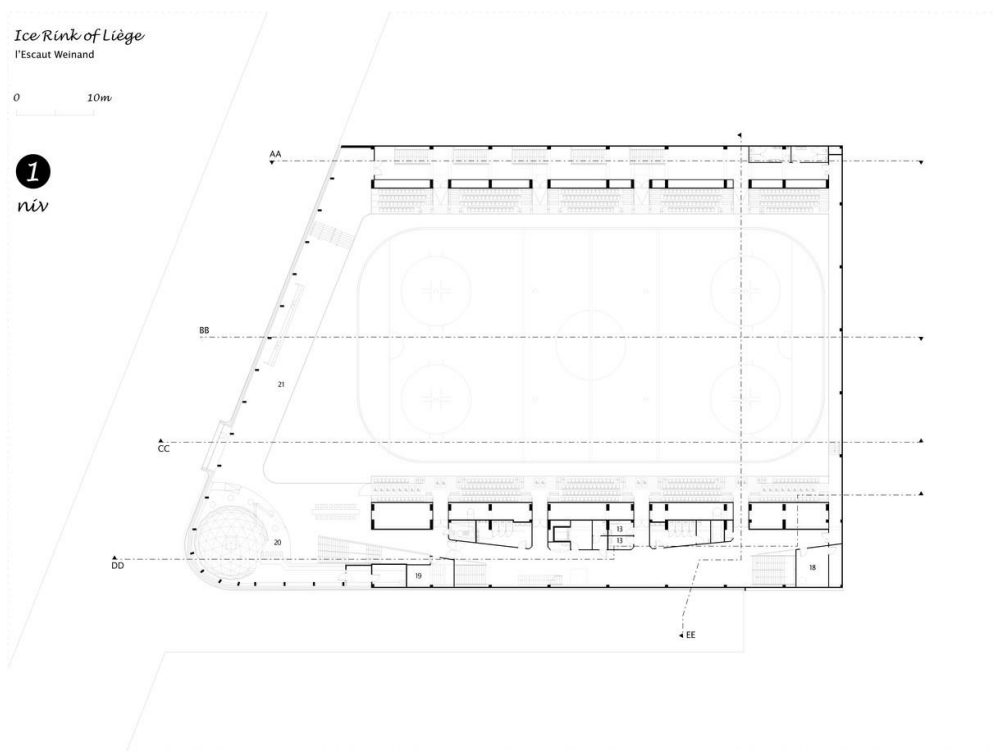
План першого поверху, арх. L'Escout Architectures + BE Weinand [5]
